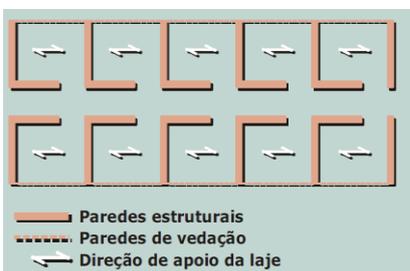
Sistema estrutural em paredes transversais (RAMALHO)
